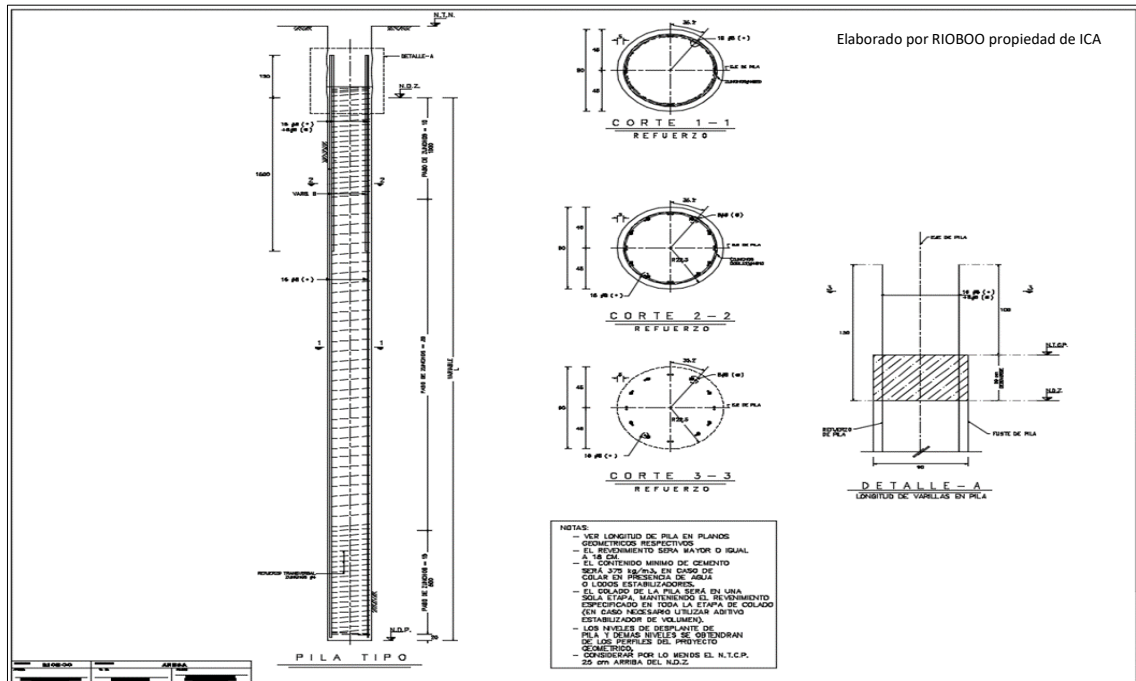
Plano estructural de una pila tipo entronque Insurgentes
